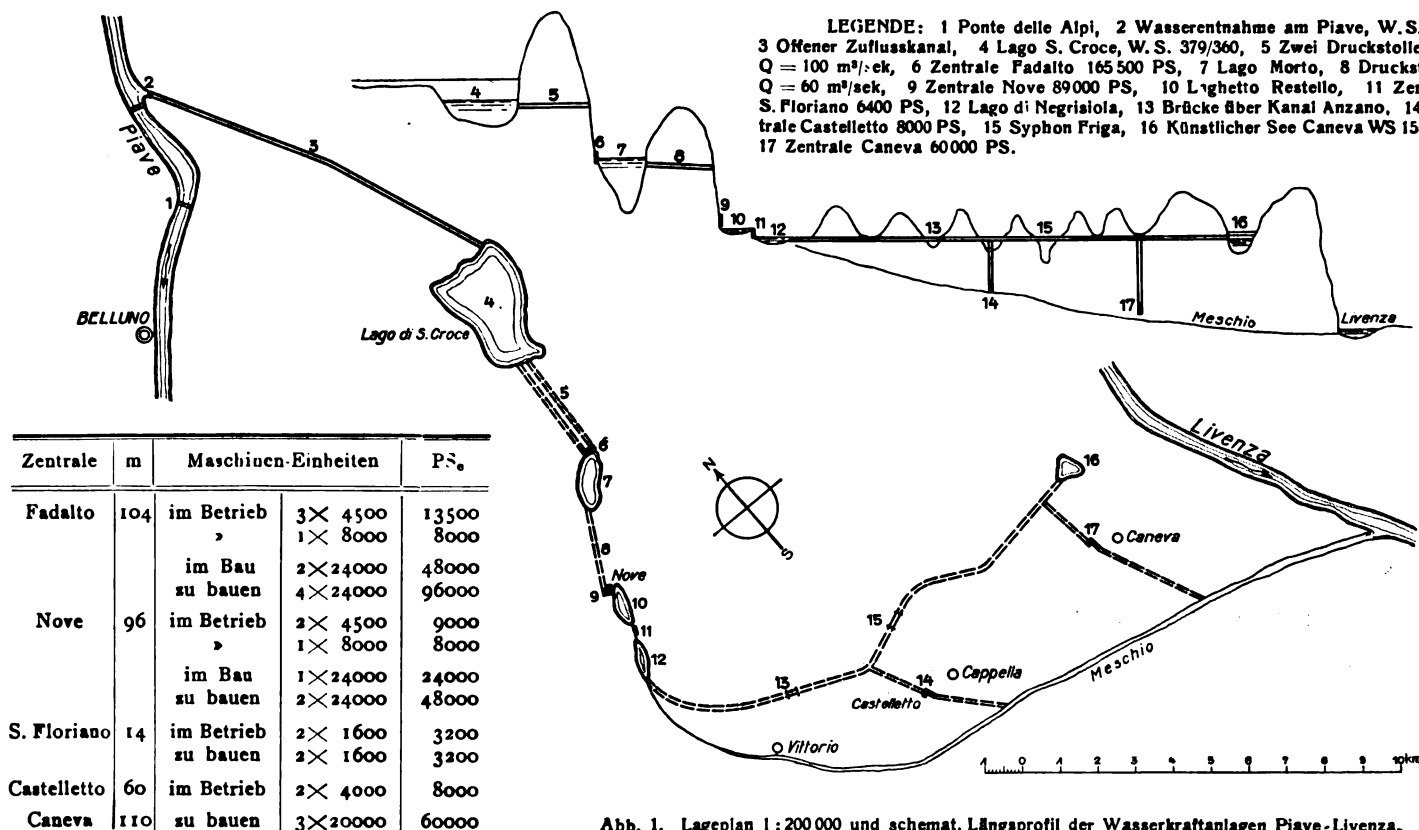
Lageplan 1:200 000 und schemat. Längsprofil der Wasserkraftanlagen Piave-Livenza.
